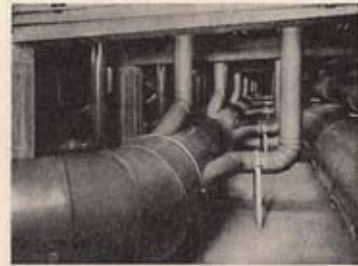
Lüftungs-Hauptsammelleitung mit eingeschweißten Stichleitungen
